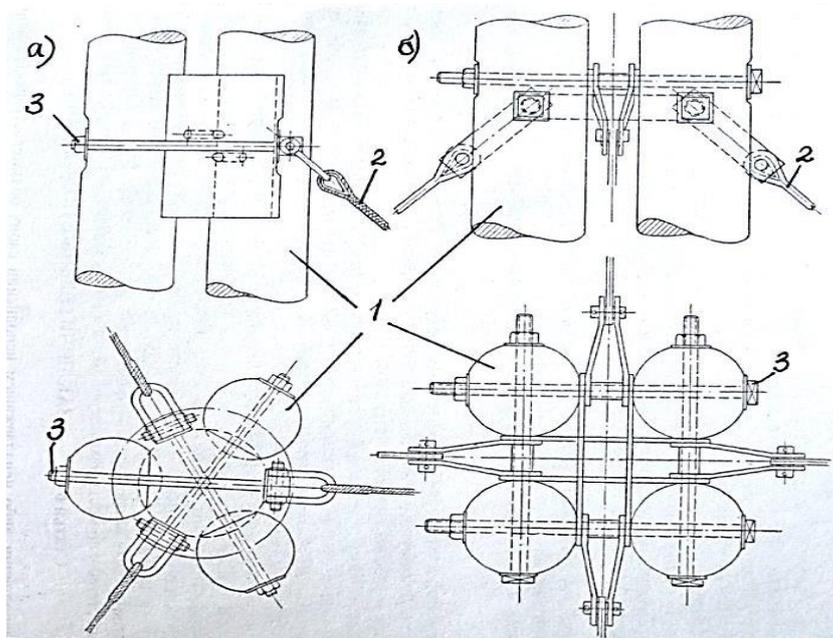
Детали конструкции крепления оттяжек к стволу кустовых мачт:
